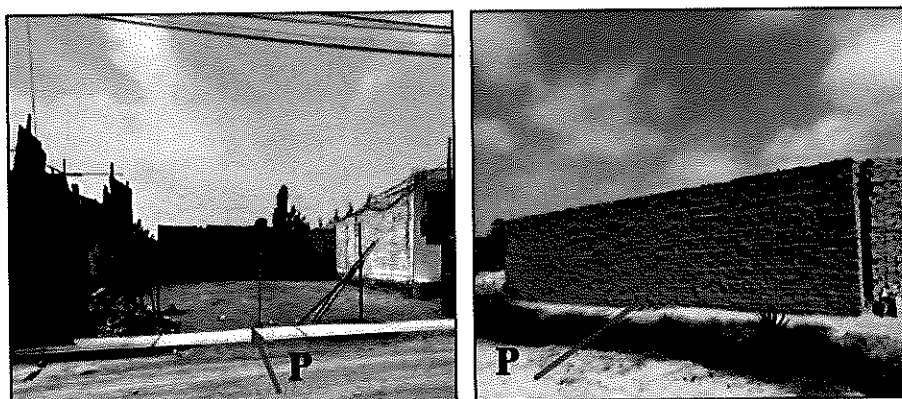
Fotografías de lotes sin construcción y con cerco sin acceso
